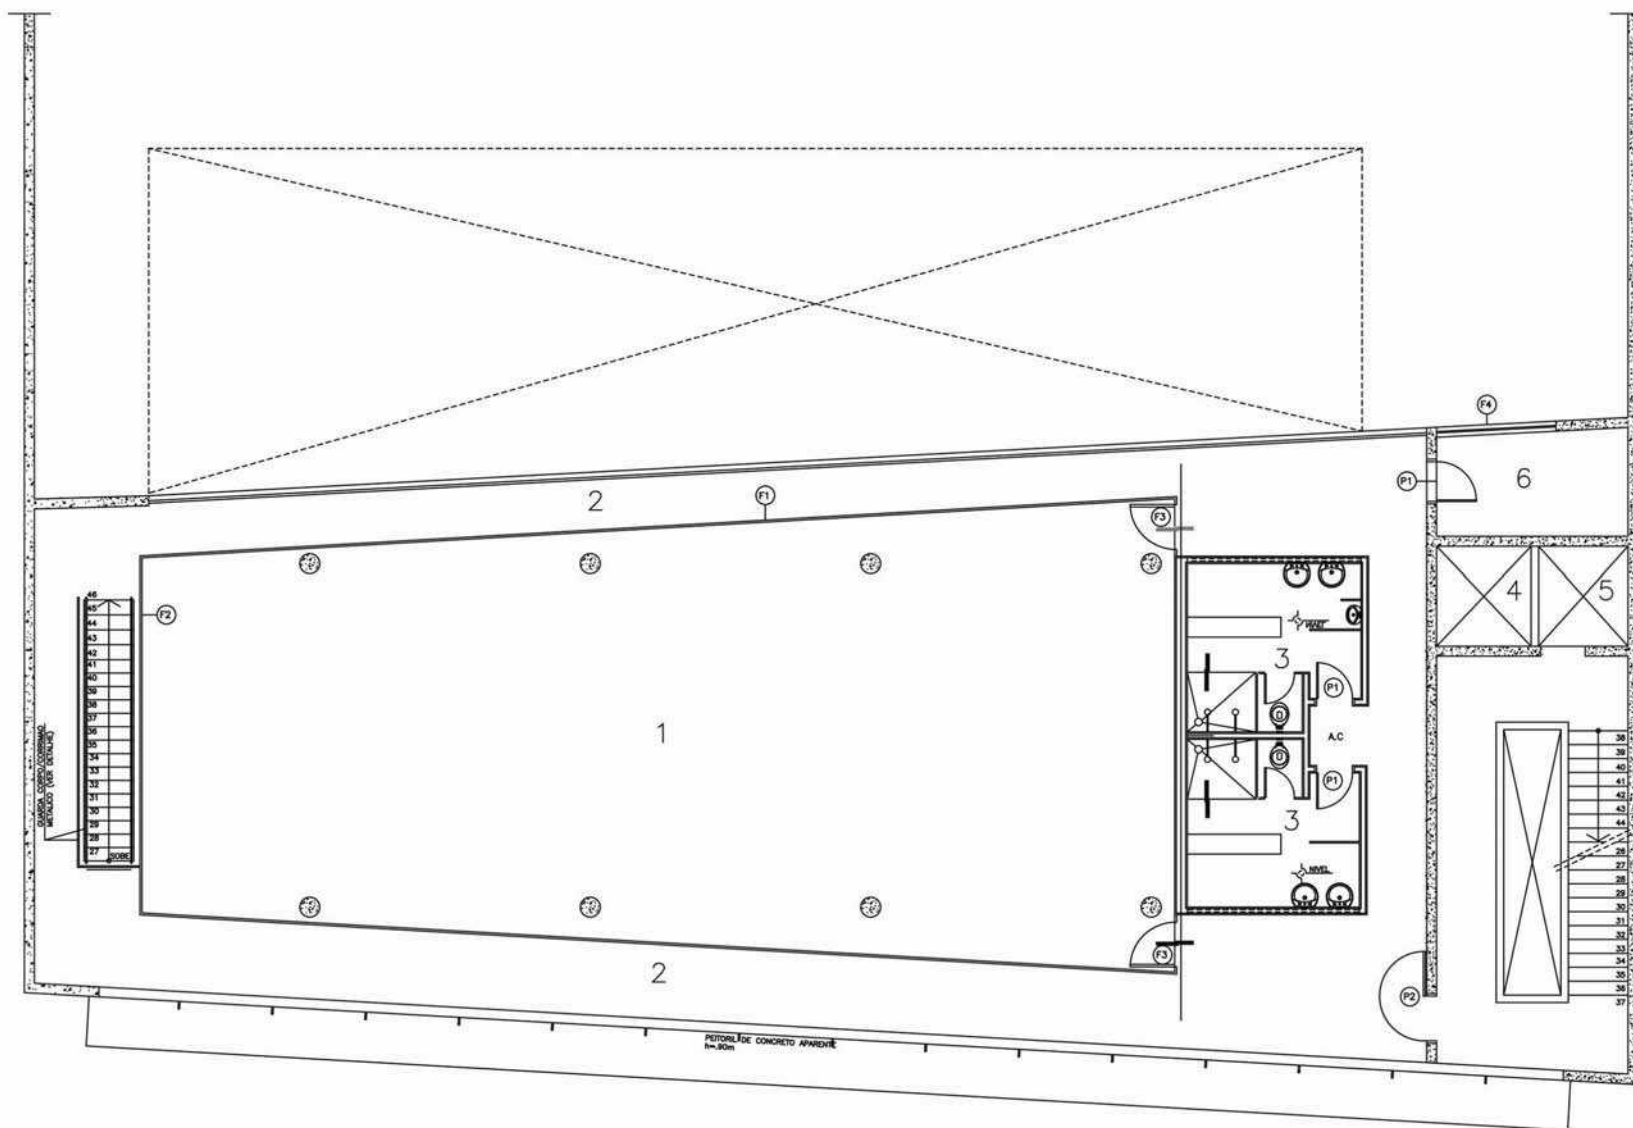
Planta do 2º pavimento do prédio novo (1. ensaios; 2. circulação; 3. vestiário; 4. monta-carga; 5. poço do elevador; 6. depósito).
